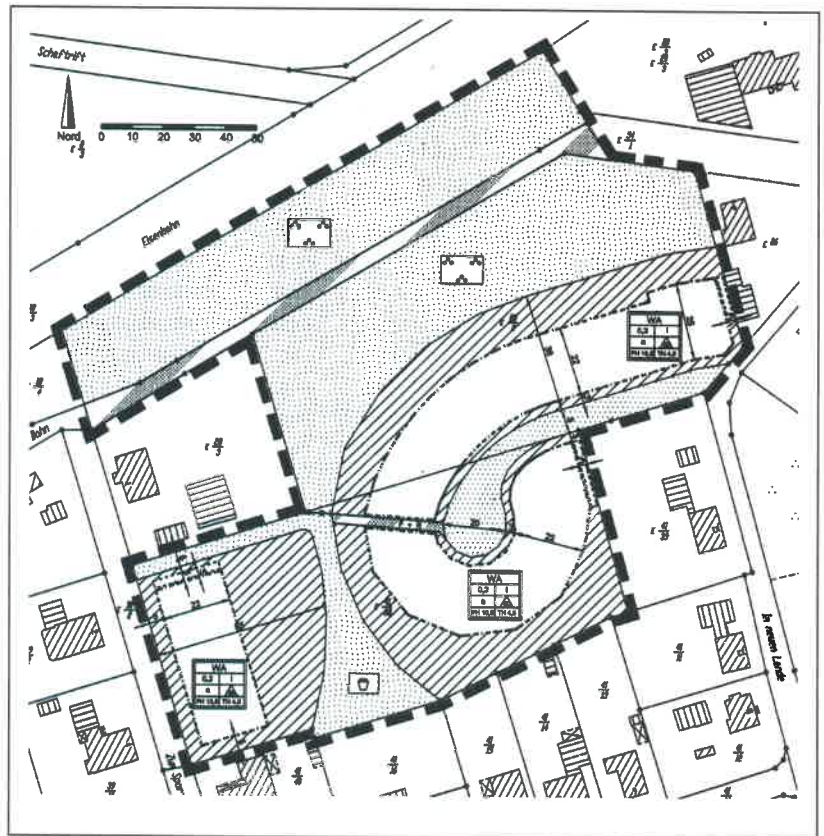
Bebauungsplan Nr. 7 „Im Neuen Lande“ i.d.F. 2010
